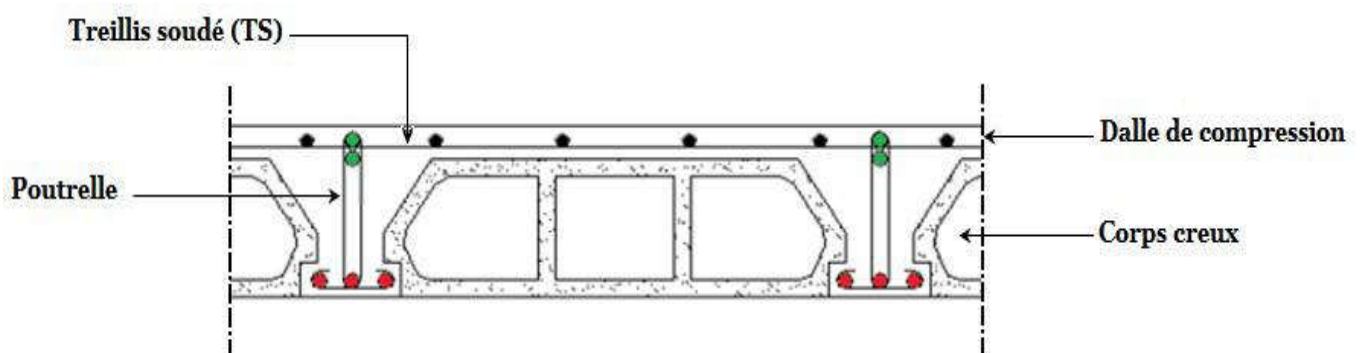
Coupe transversale d'un plancher à corps creux.
